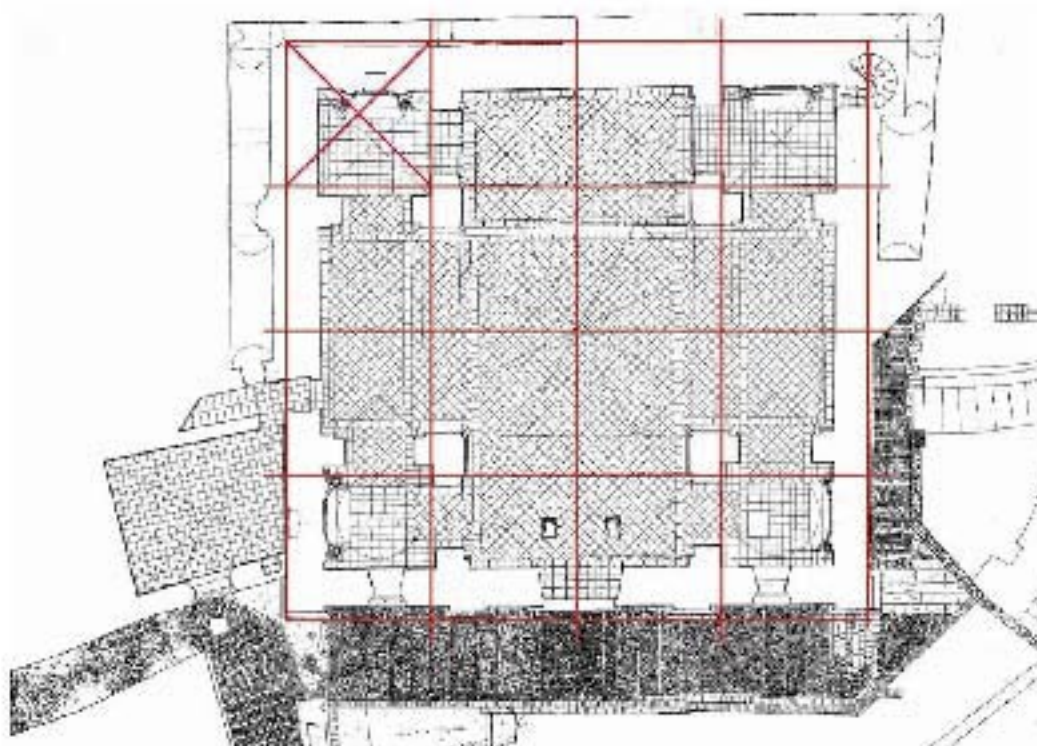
Grotto di Grotto. Chiesa di Santa Lucia. Pianta del piano della chiesa. In rosso è evidenziata la modularità dell'impianto planimetrico.
